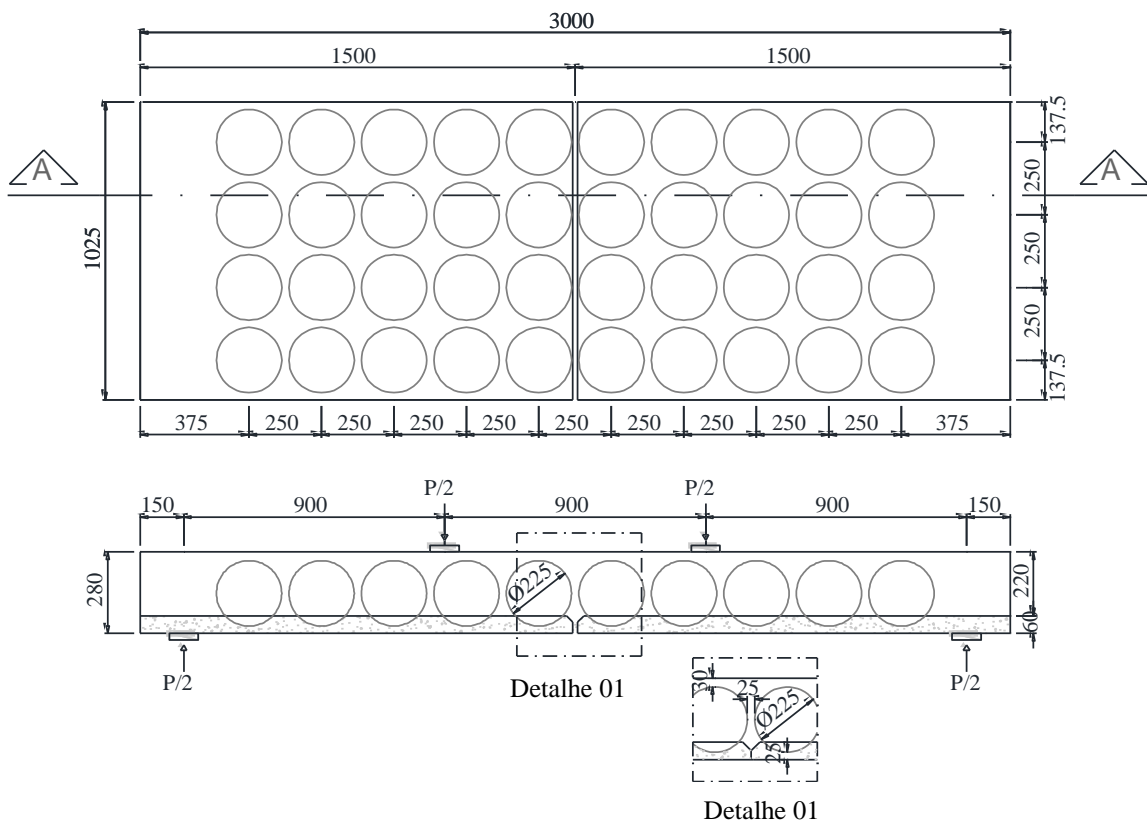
Laje *BubbleDeck* BD28-F2 (dimensões em mm)
